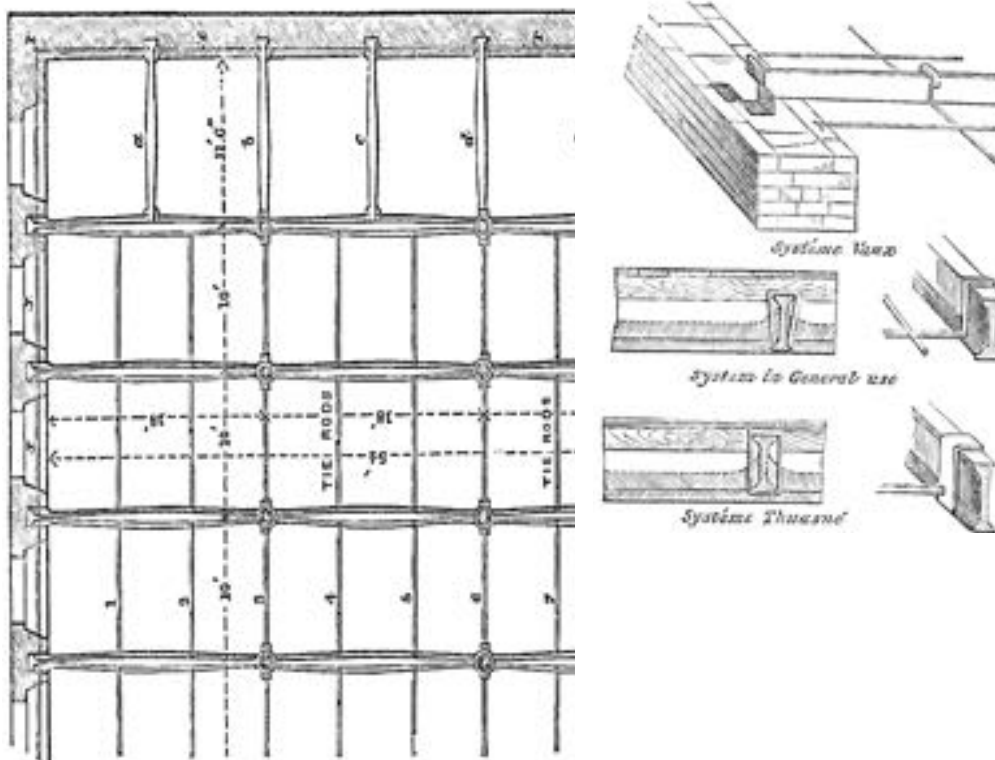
| Esempio di realizzazione di solaio con sistemi in ghisa e ferro su struttura perimetrale in muratura. "Cast and Wrought Iron to Building Purposes, Longman, Green, Roberts, 1864".
